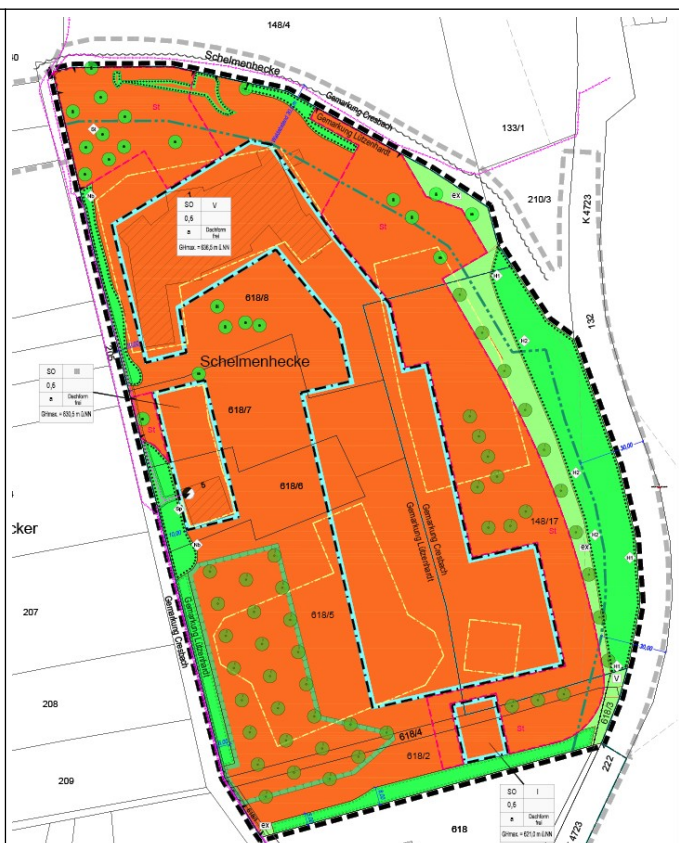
Bebauungsplan „Schelmenhecke“ - 3. Änderung (Ausschnitt aus dem geänderten Entwurf zur erneuten Offenlage)
